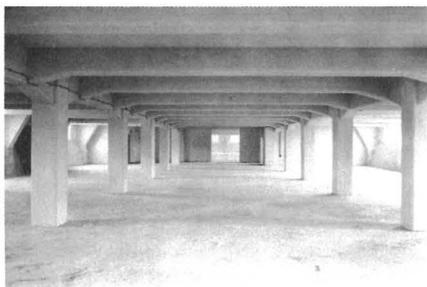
Das Innere der ehemaligen Salzhalle. Zur Lagerung von Munitionsteilen sind die Decken mit einer Eisenbetonkonstruktion verstärkt
